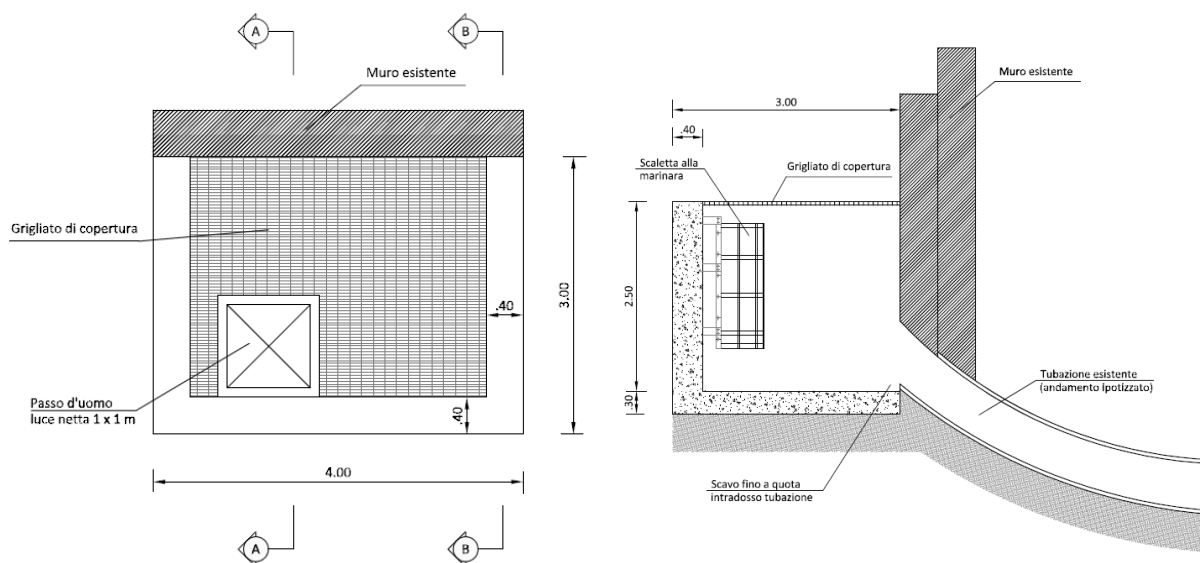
Planimetria e sezione del nuovo pozzetto di progetto estratti dall'elaborato "Opere di regimentazione idraulica\_Carpenterie e armature pozzetto"
